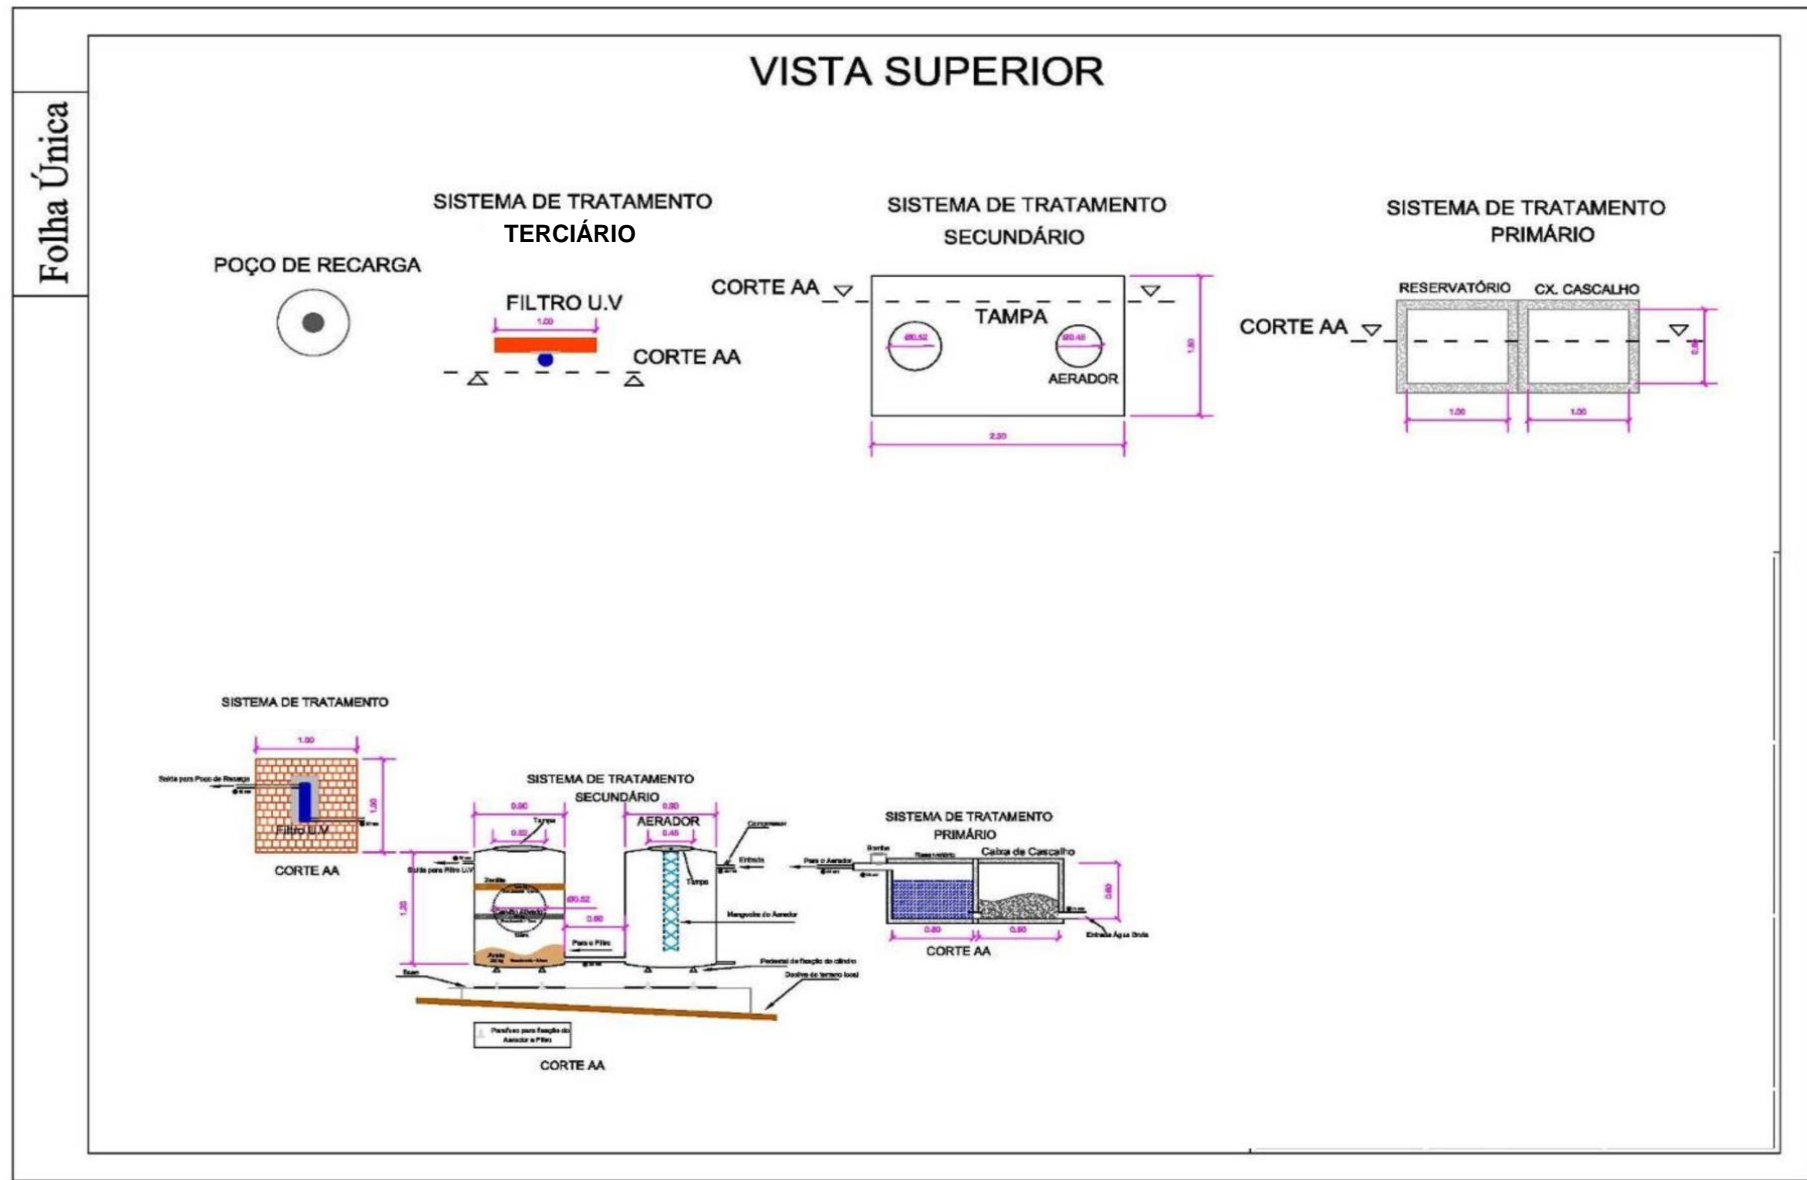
Planta baixa, detalhe da Estação de Tratamento Simplificada - ETS.
